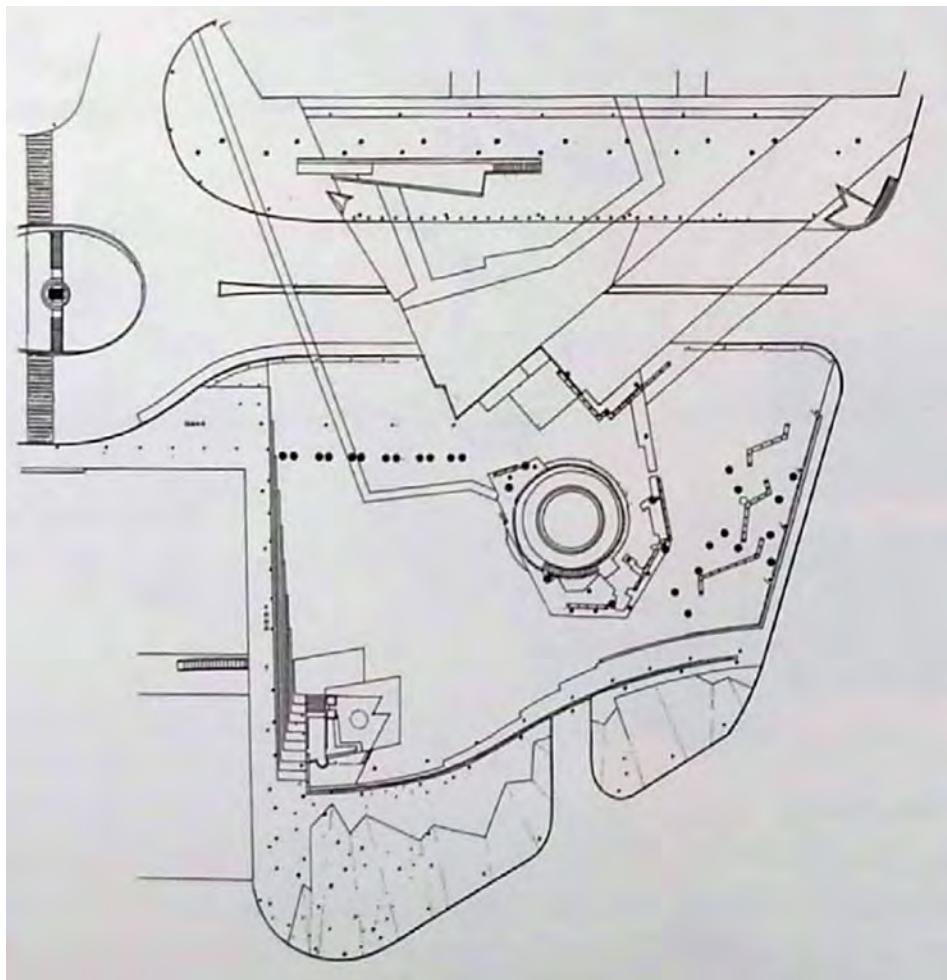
M. Solà-Morales Rubió, *Plano geométrico de trazas y pavimentos [Planimetria geométrica di tracce e pavimenti]*, 1988-1989, M. de Solà-Morales Rubió, *Plaza de la Marina, Málaga*, "Geometría", 1992, 14, pp. 5-20: 6.
